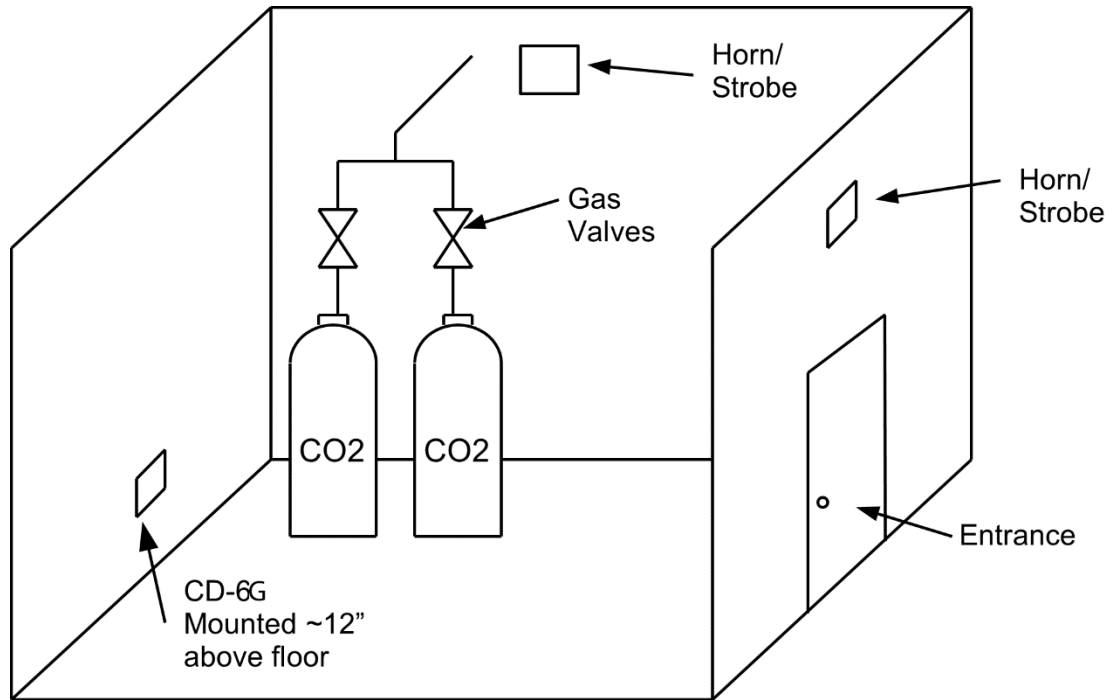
CD-6G Exemple d'emplacement de montage possible
